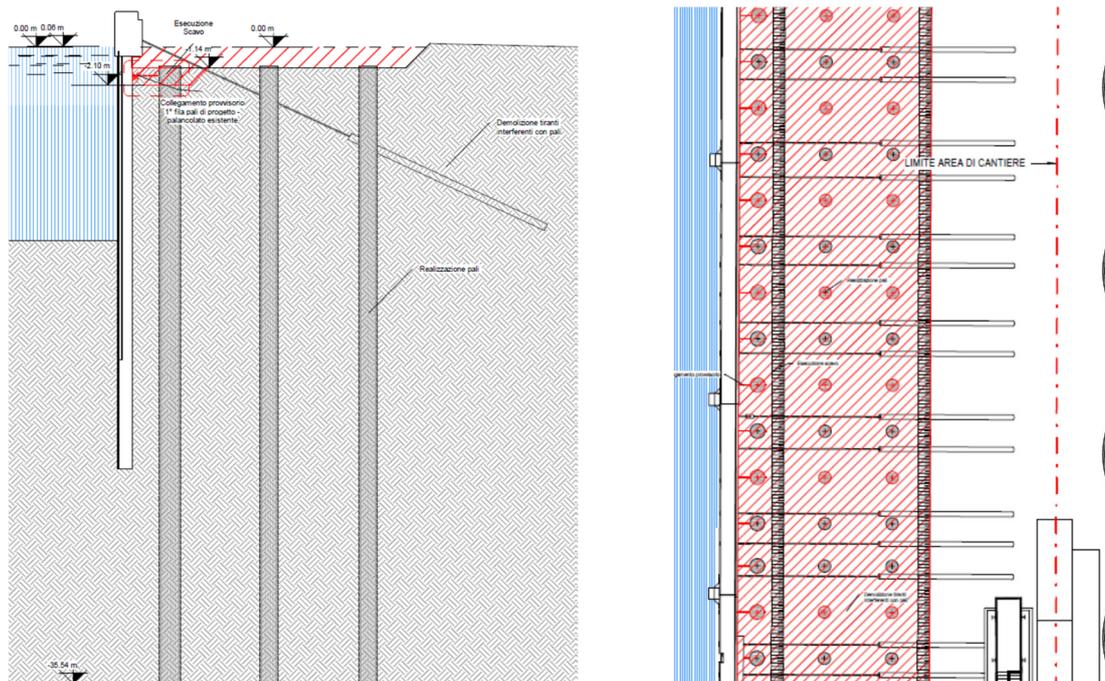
Banchina Bunge Sud – Fase 5 – Sezione e planimetria
